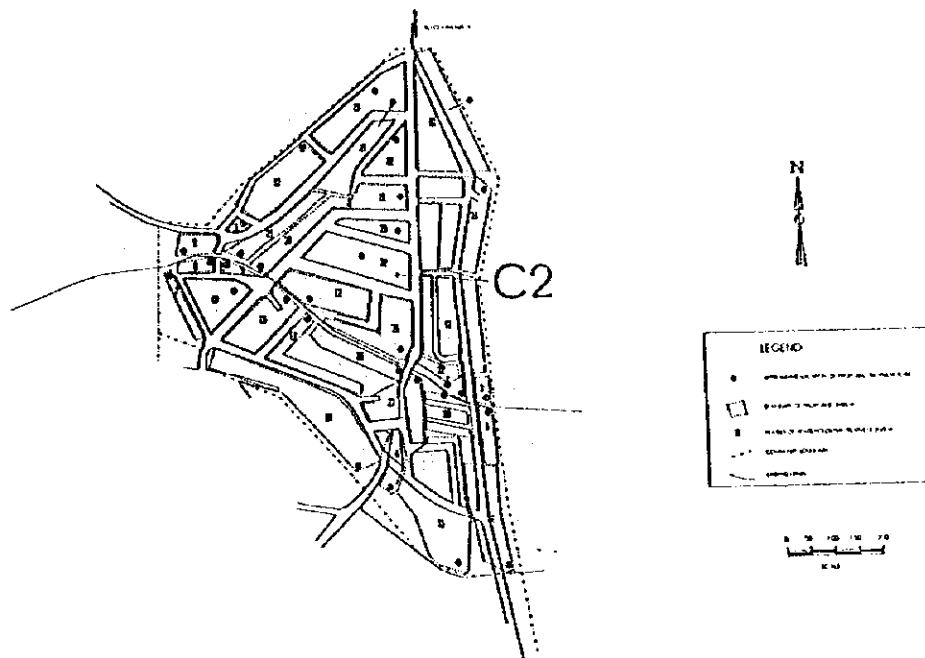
Plan de Distribución de los Sistemas *In-Situ
